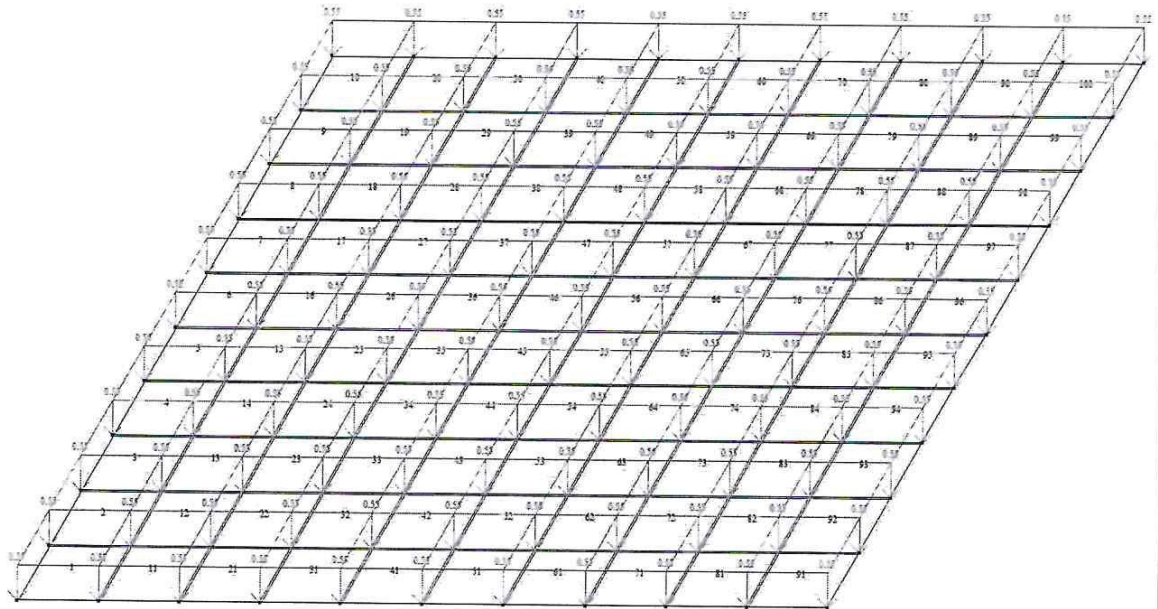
Нагрузки на плиту перекрытия шахты от лифтового оборудования.
